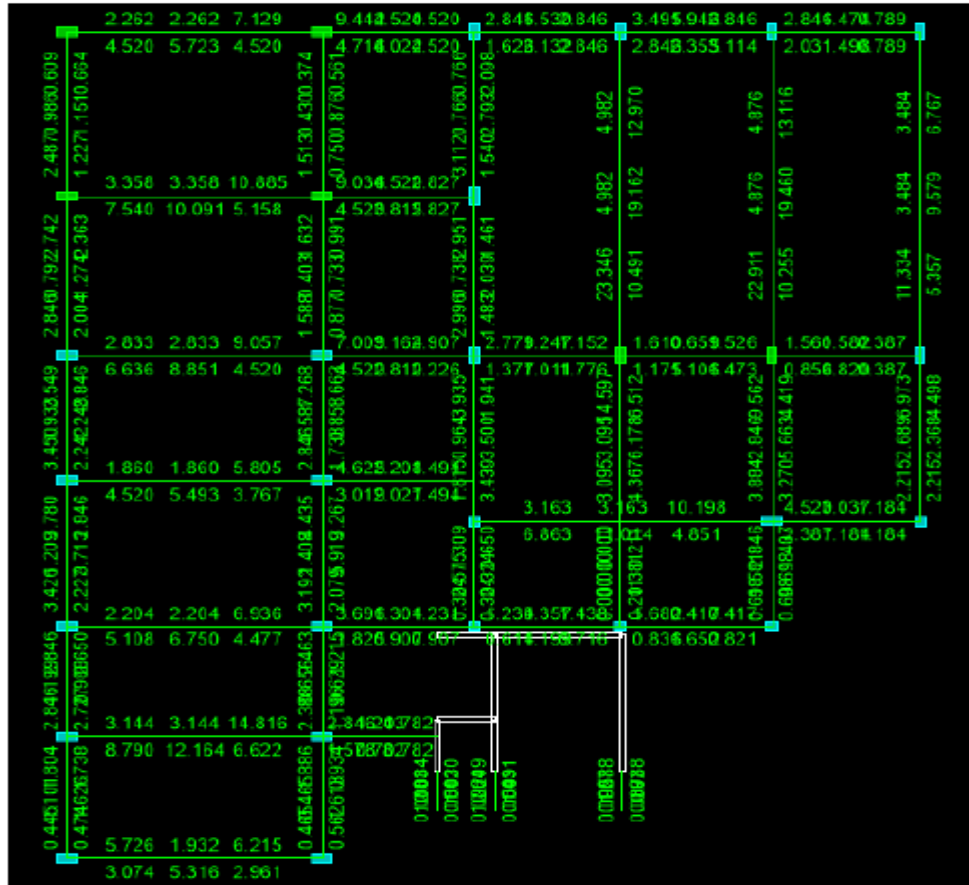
Área de acero de refuerzo en vigas Primer Techo (cm²)
